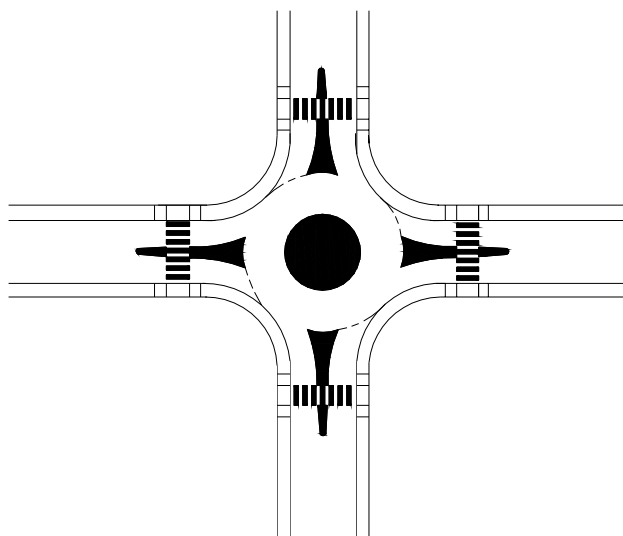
Mini-rotunda (FHWA, 2000)
